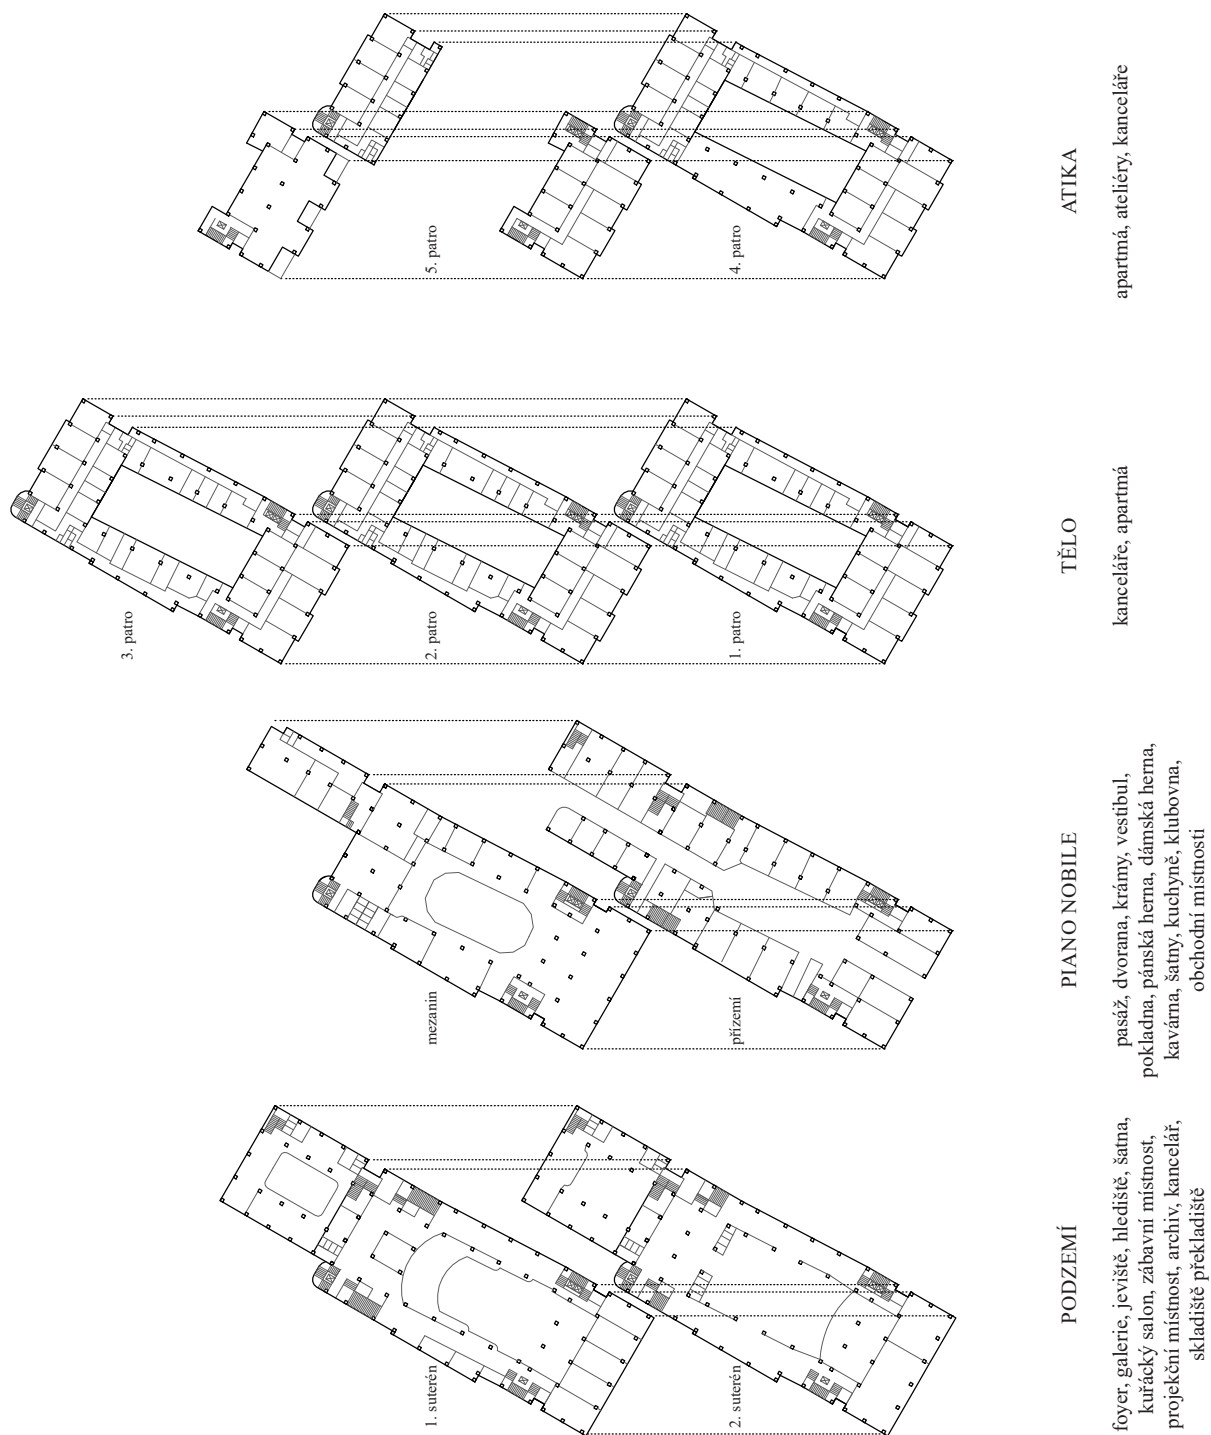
Rozložené plány paláce U Nováků 1:1500.
